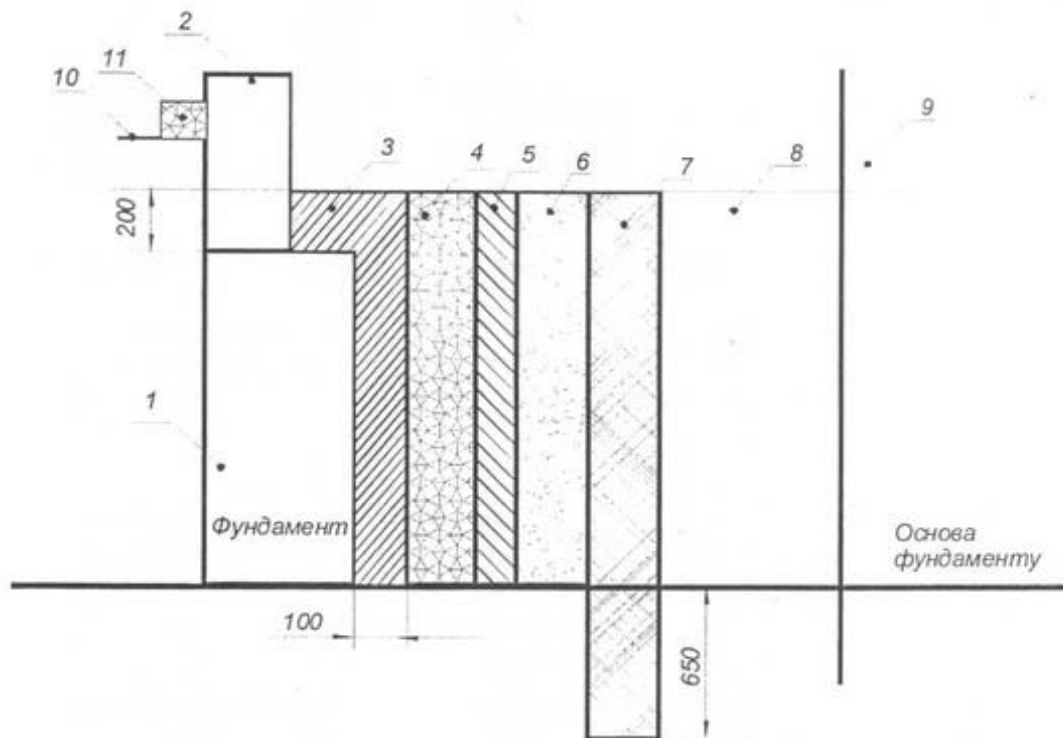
Віброшумозахисна конструкція будівельних споруд і фундаментів «Дембас», де:
